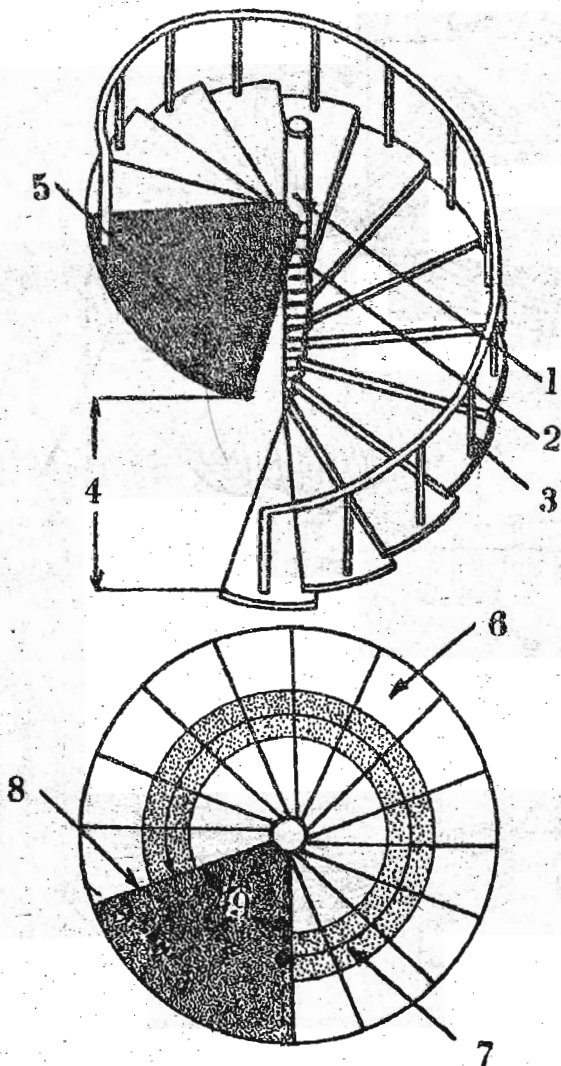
Винтовая лестница с деревянными ступенями (вид сверху).
